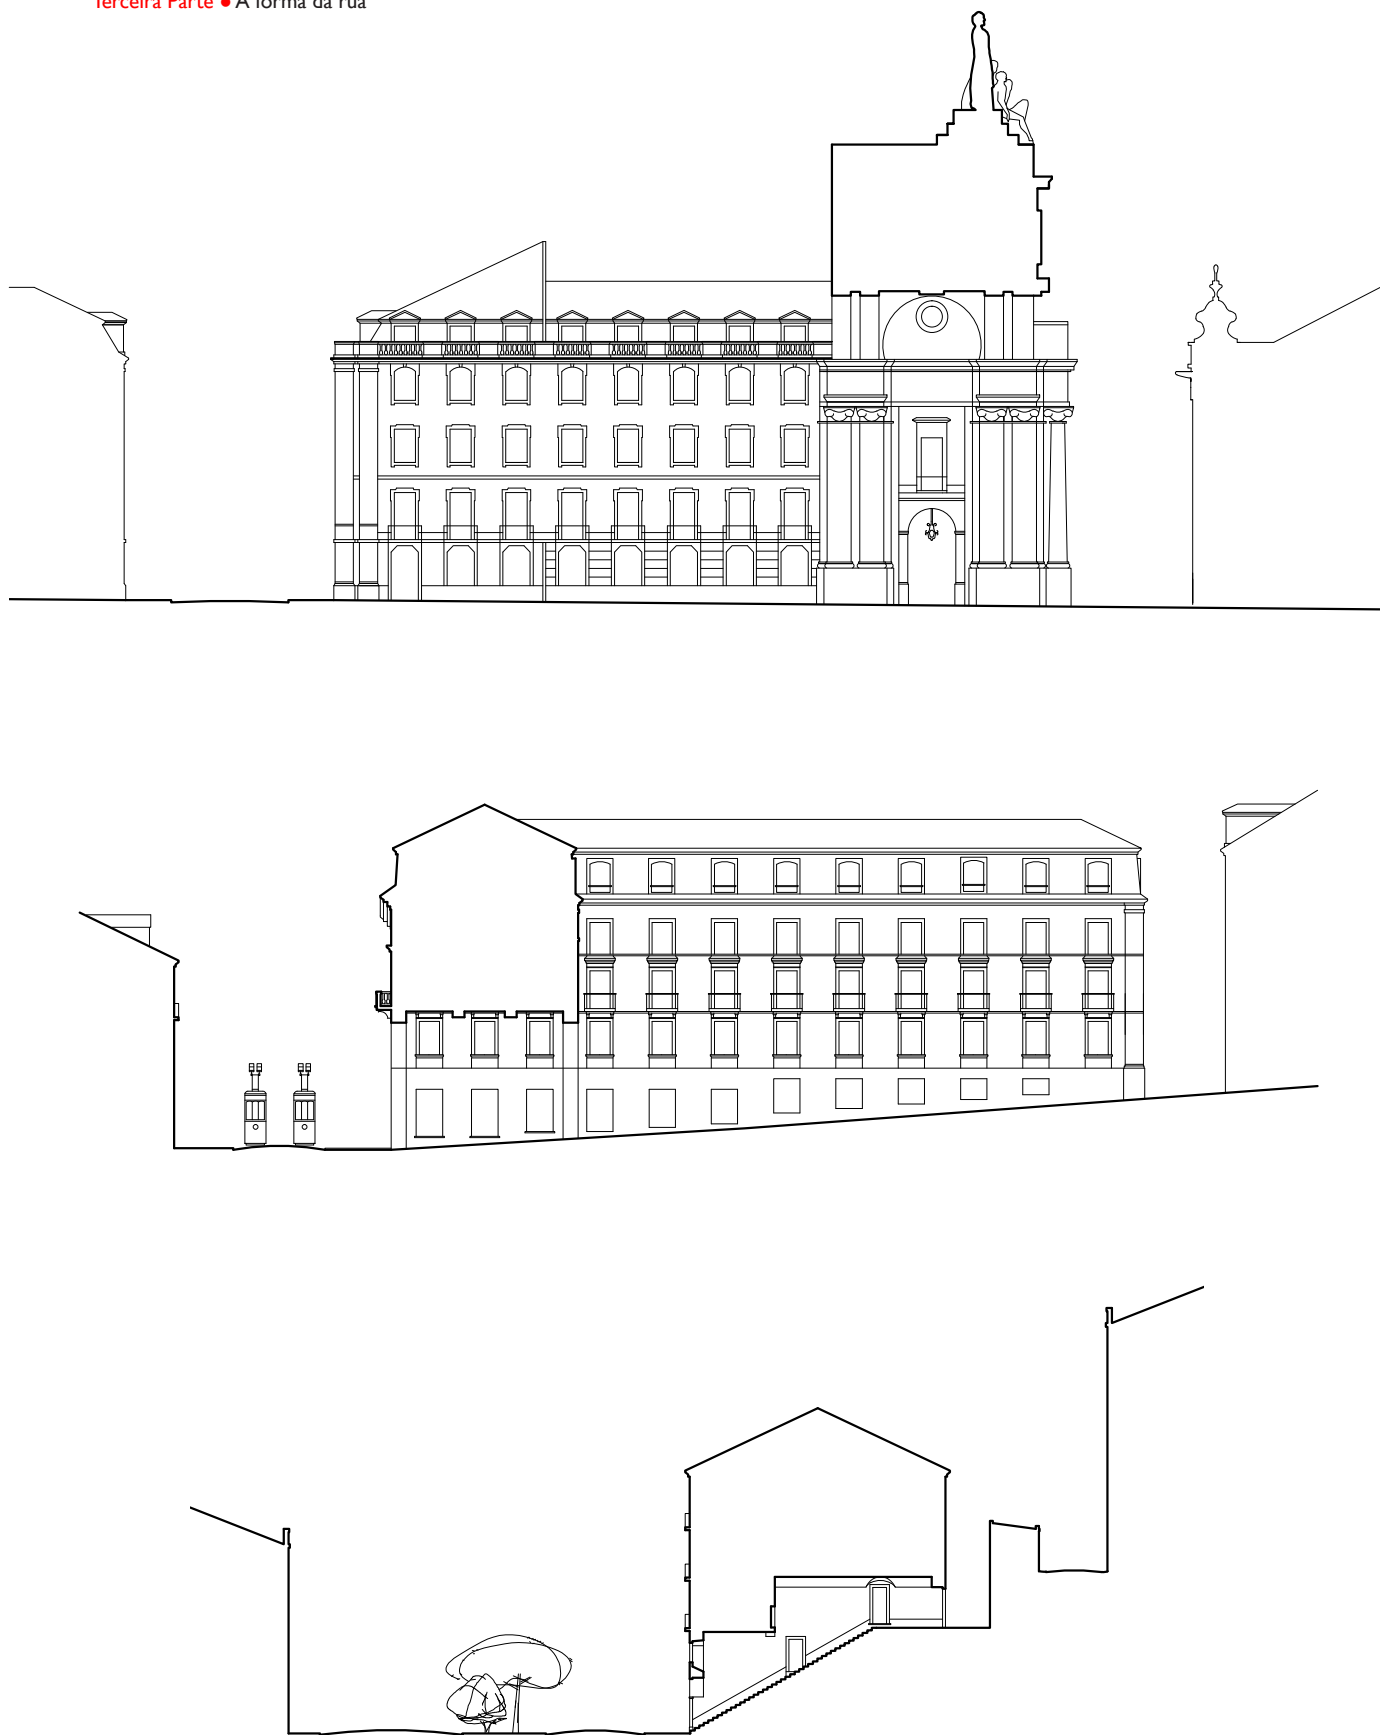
• Secções com o plano horizontal simples que atravessa edifícios. Secções longitudinais (1:500).
